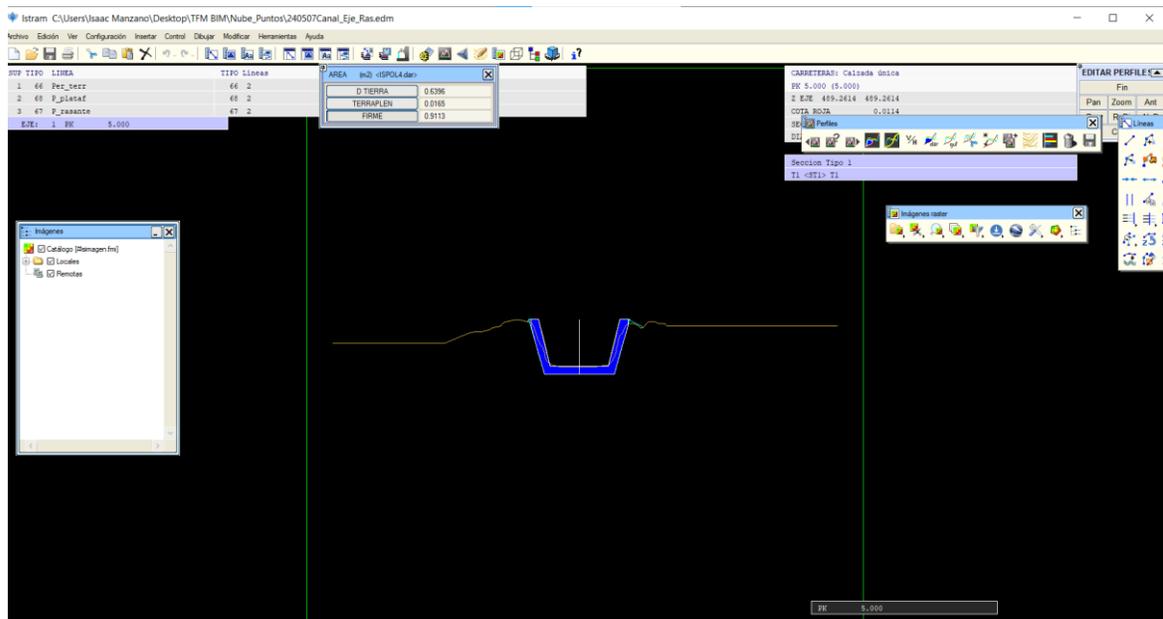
Sección de canal en ISTRAM (Elaboración: fuente propia)
